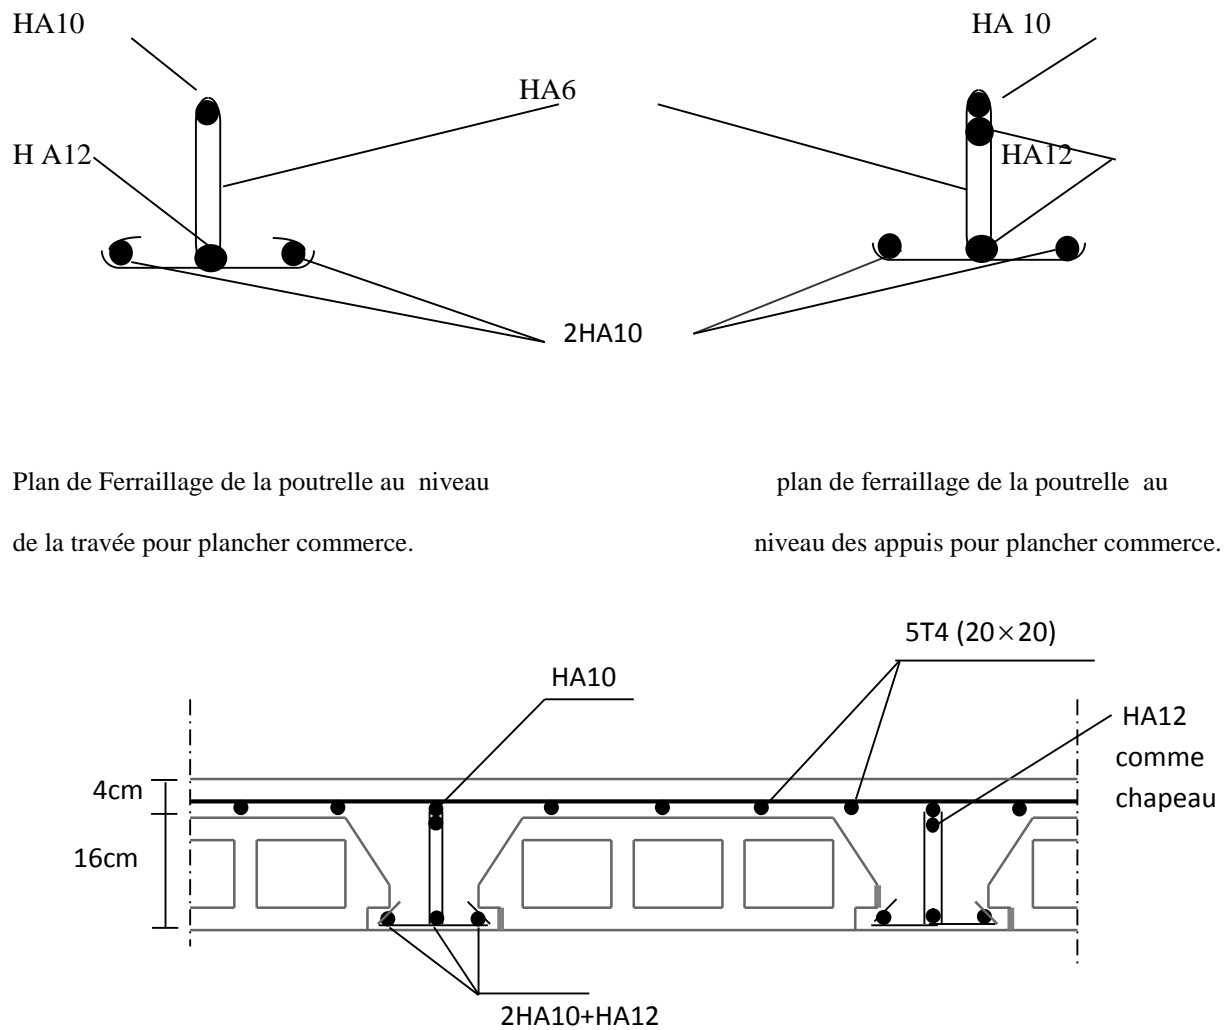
Plan de ferrailage du plancher étage a usage commercial.
